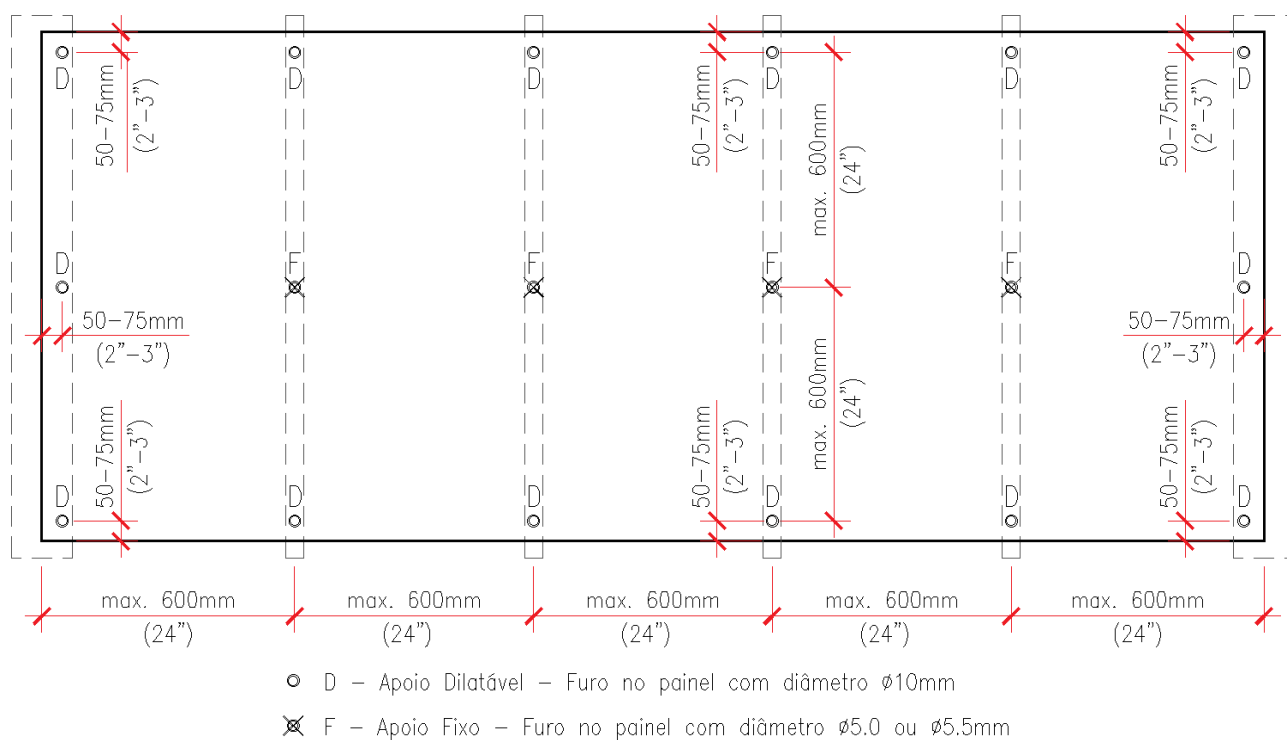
Fixações de painéis de teto, aplicados no exterior
